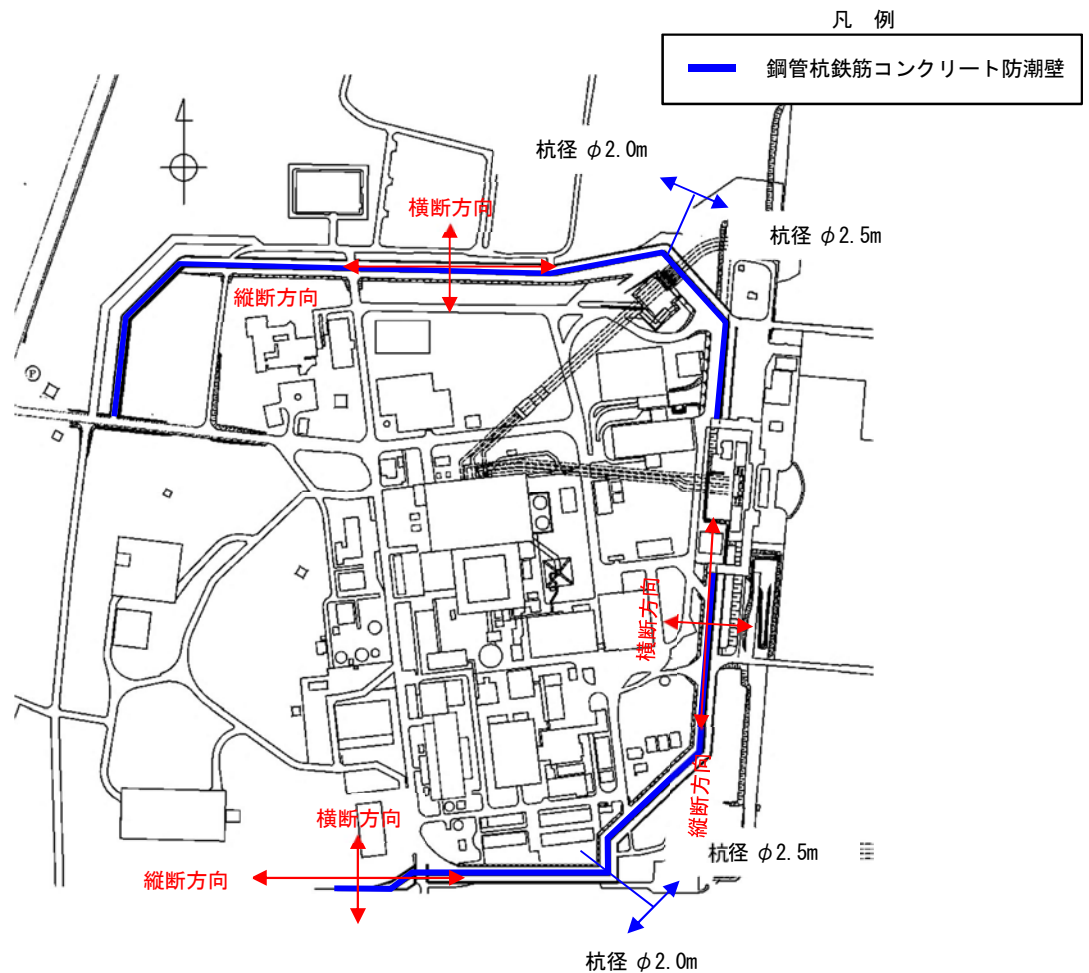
鋼管杭鉄筋コンクリート防潮壁の平面配置図
